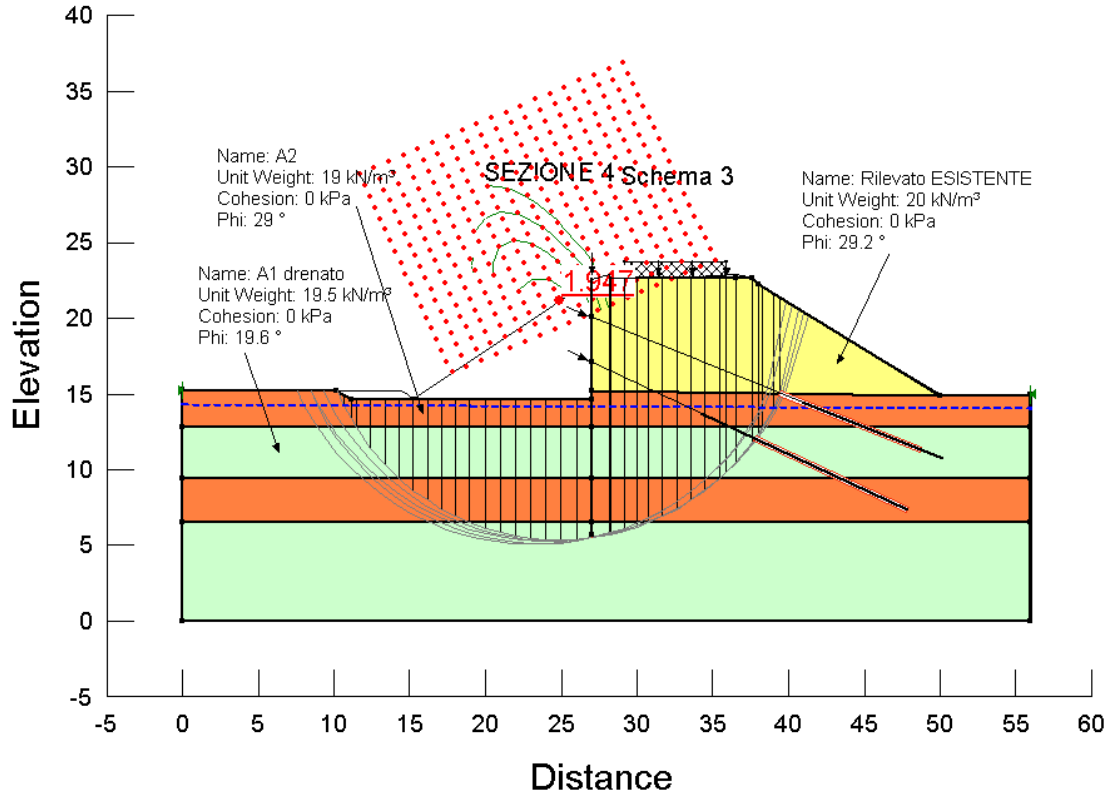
Verifica di stabilità globale palancola SCHEMA 3
